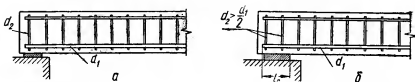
Анкеровка сварных каркасов на свободных опорах балок:
